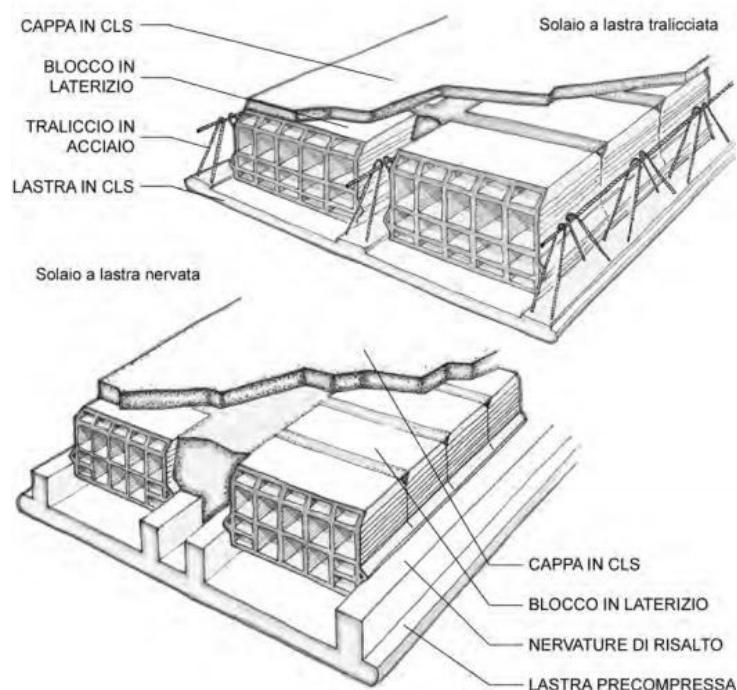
Solaio a lastra (fonte: La corretta esecuzione dei solai in laterizio, archivio Biblus online)
